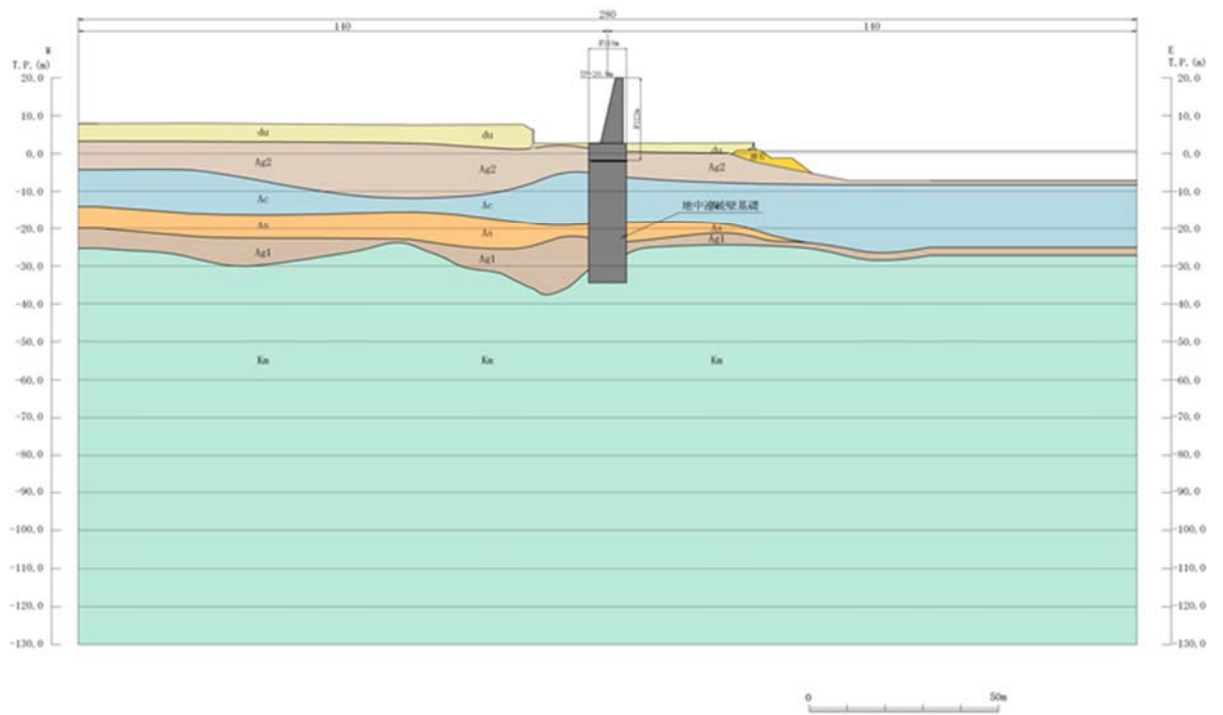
評価対象断面図（排水系統Ⅳ-1）
